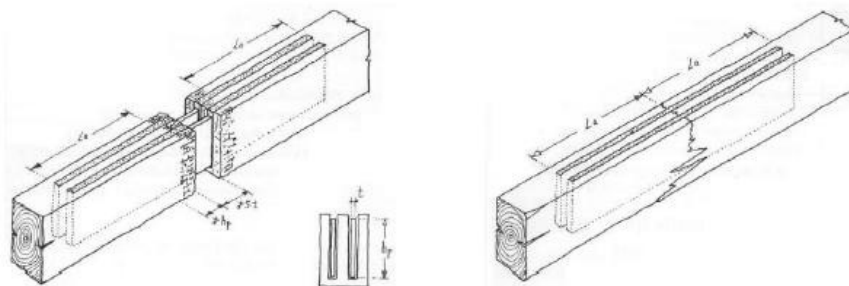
Aplicação de placas de reforço em vigas seladas com cola epoxídica (Arriaga, F., 2002).
